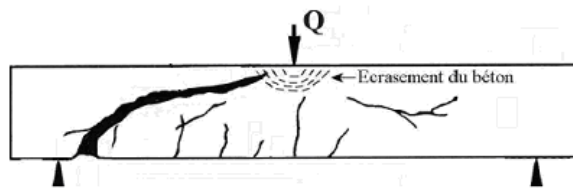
Schéma d'une poutre endommagée par la compression du béton dans les bielles [CROSTON\_06]
